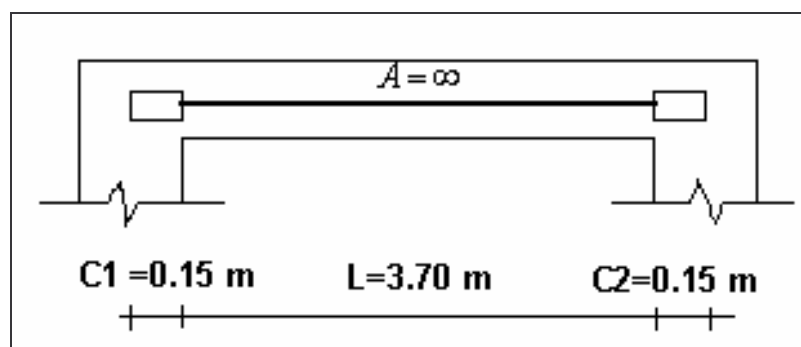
Geometría de la viga con dos sectores de rigidez infinita.
